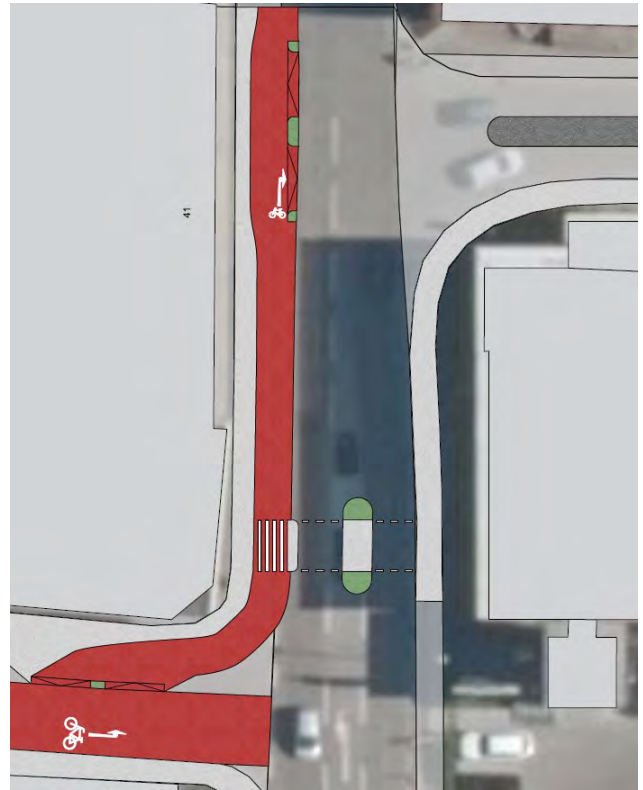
Radverkehrsführung im Bereich Nordstraße-Grüntenstraße-Ostrachstraße
